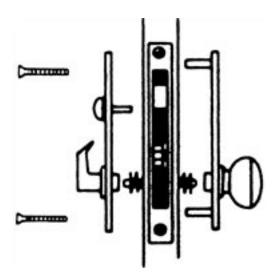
Установка цилиндра (С разрешения компании Schlage Lock Company)
